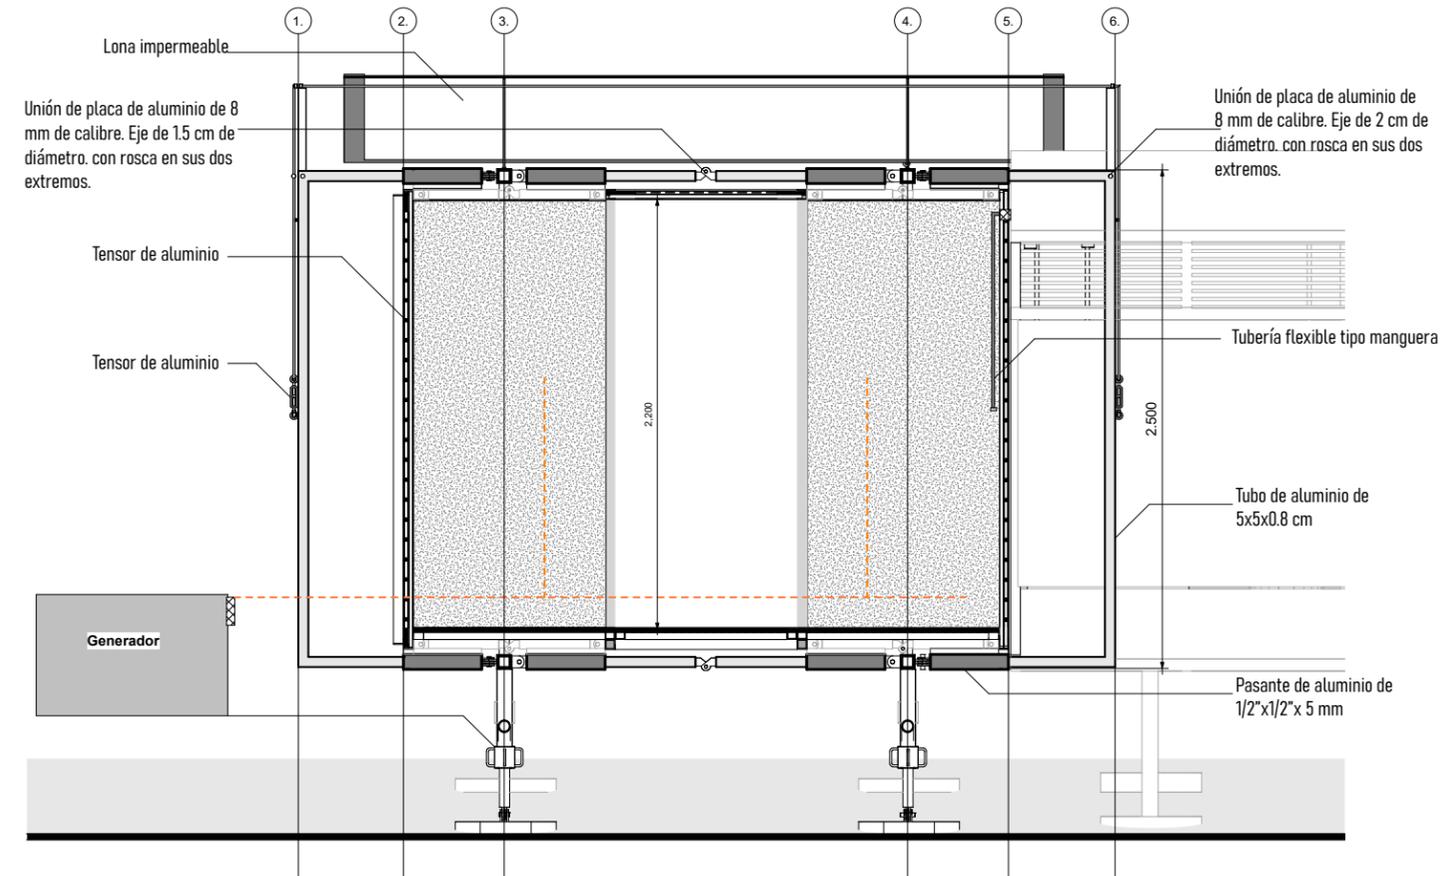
Sección B-B. Fuente: Elaboración propia.
